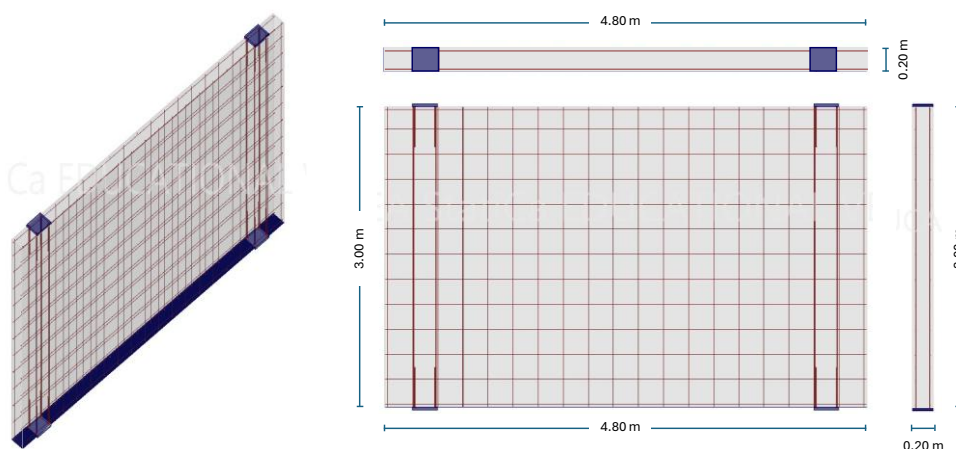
Representação geométrica da parede-tipo ($4.80 \times 3.00 \times 0.20 \text{ m}^3$, com ligações secas): planta, alçado, perfil e vista em perspetiva, *IDEA StatiCa Detail*.
